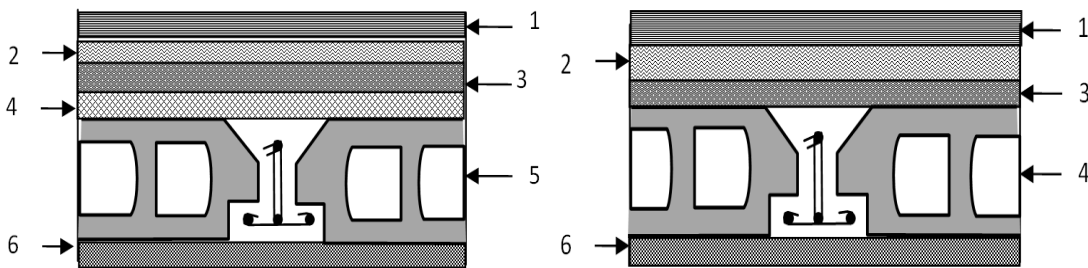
Coupe transversale d'un plancher terrasse inaccessible et étage courant
